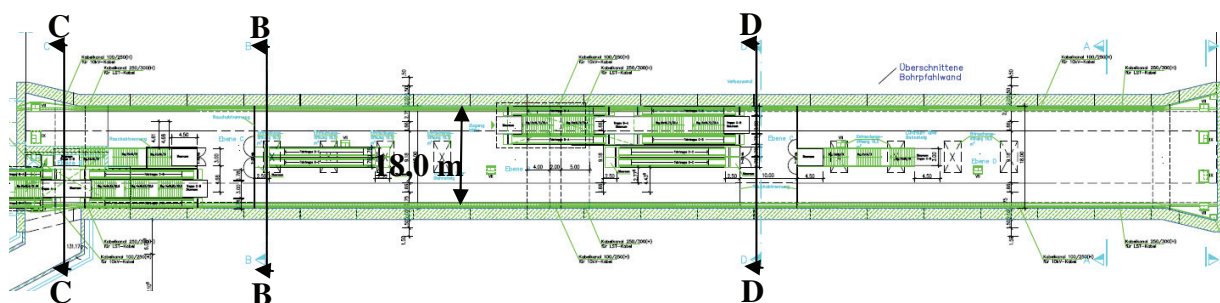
Grundriss Ebene C der Station nach [A-2]
